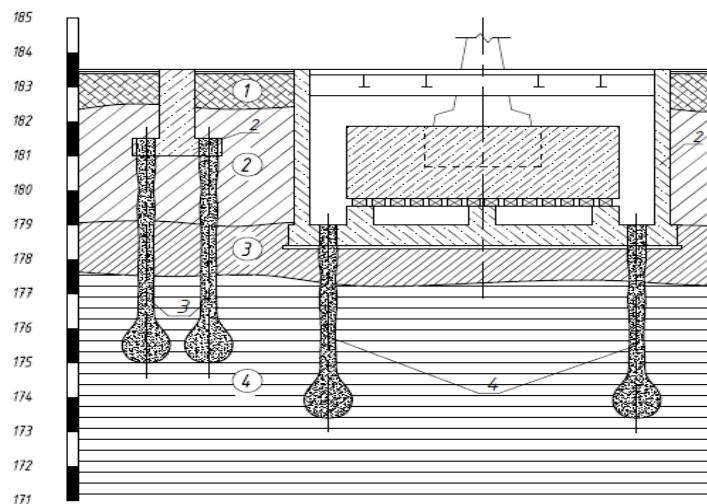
Инженерно-геологический разрез: 1 – фундамент каркаса здания; 2 – фундамент кузнечного молота; 3 – буринъекционные сваи-ЭРТ усиления основания фундаментов каркаса; 4 – буринъекционные сваи-ЭРТ усиления основания фундаментов кузнечных молотов; «1» – насыпной слой; «2» – суглинок тугопластичный; «3» – суглинок мягкопластичный; «4» – глина алевритовая тугопластичная
